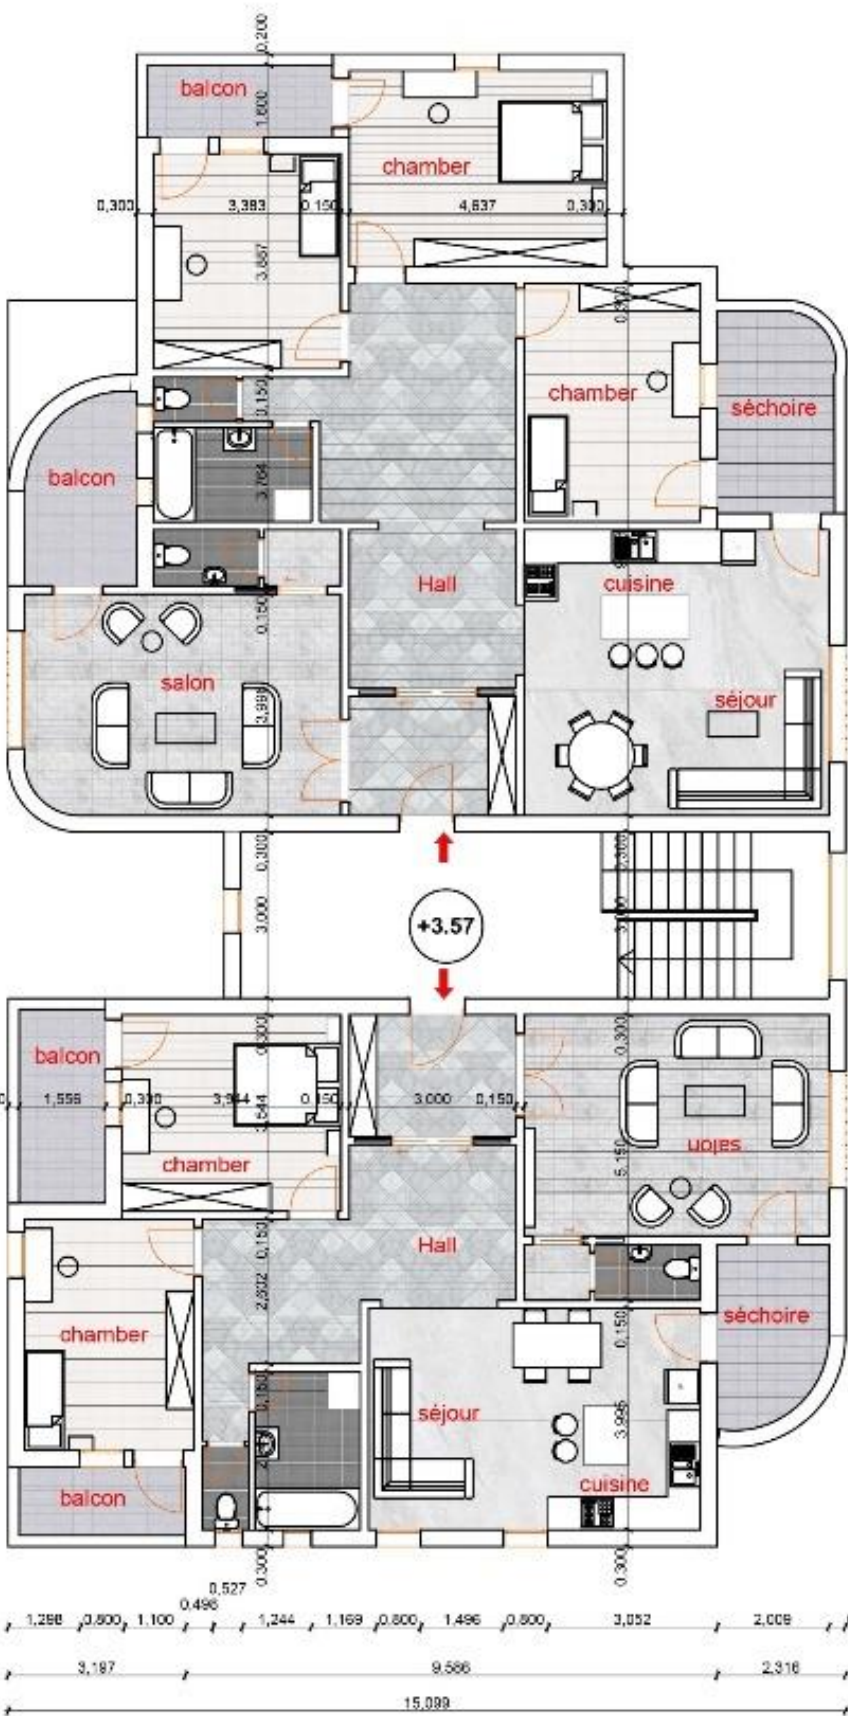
plan RDC +2ème étage Type -1- . échelle 1/100
